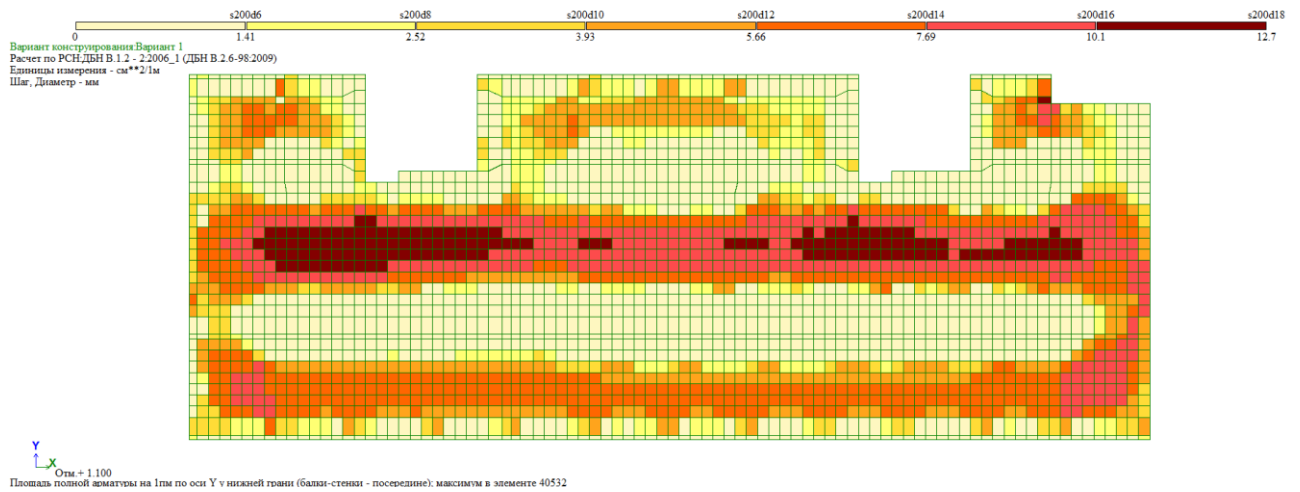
Розрахункове армування нижньої грані плити перекриття на відм. +1,100 вздовж осі Y від основних сполучень навантажень
